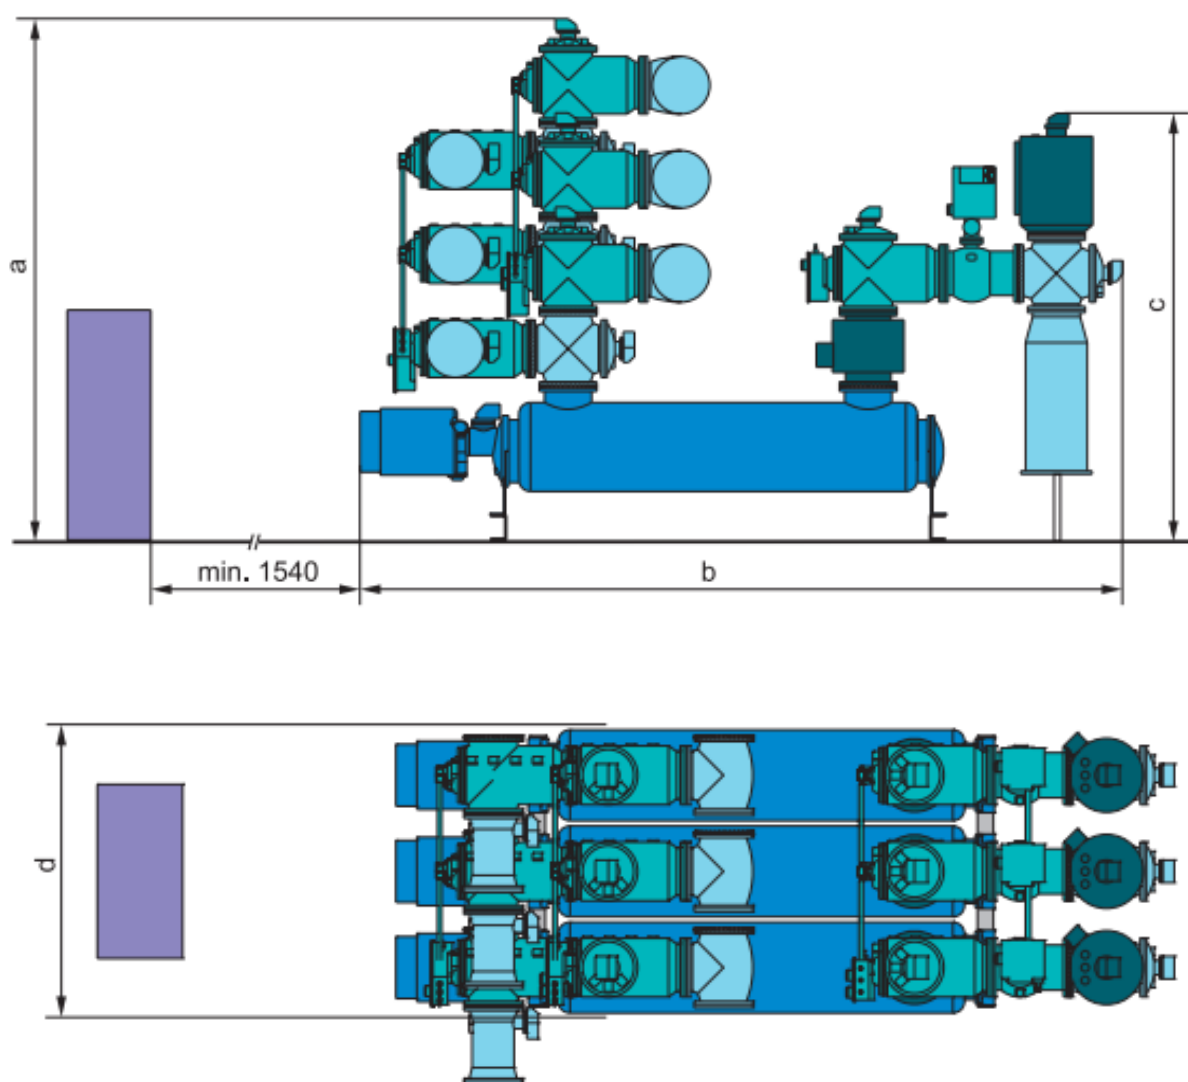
Внешний вид ячейки КРУЭ 500 кВ
